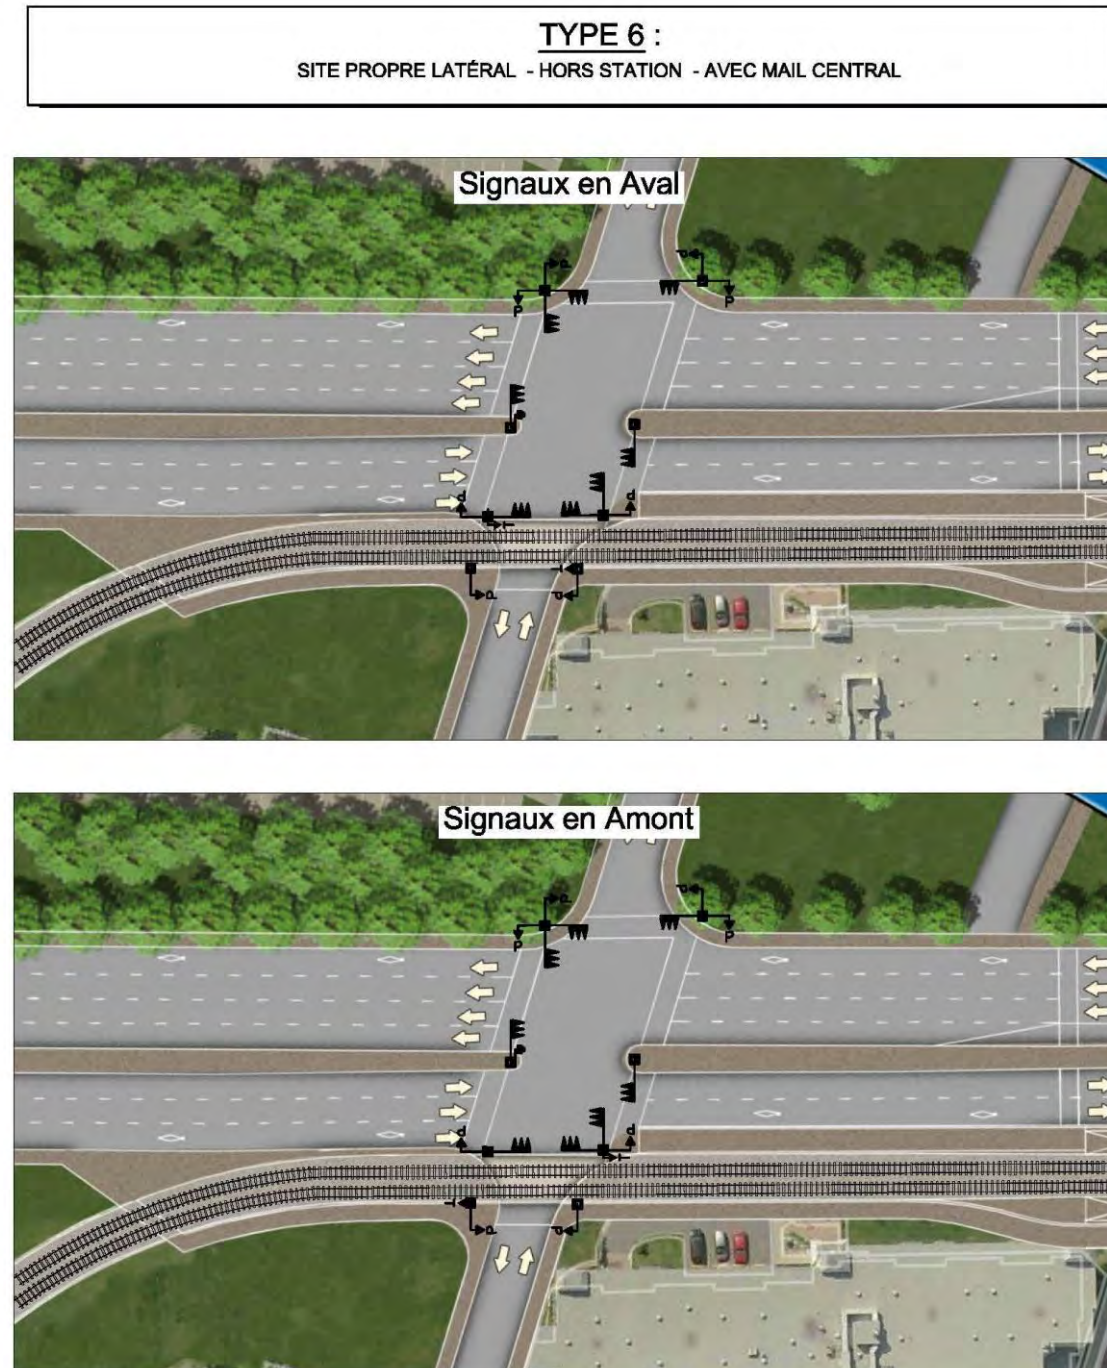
Disposition des signaux lumineux aux carrefours pour le tramway en site propre en position latérale – hors station – avec mail central
